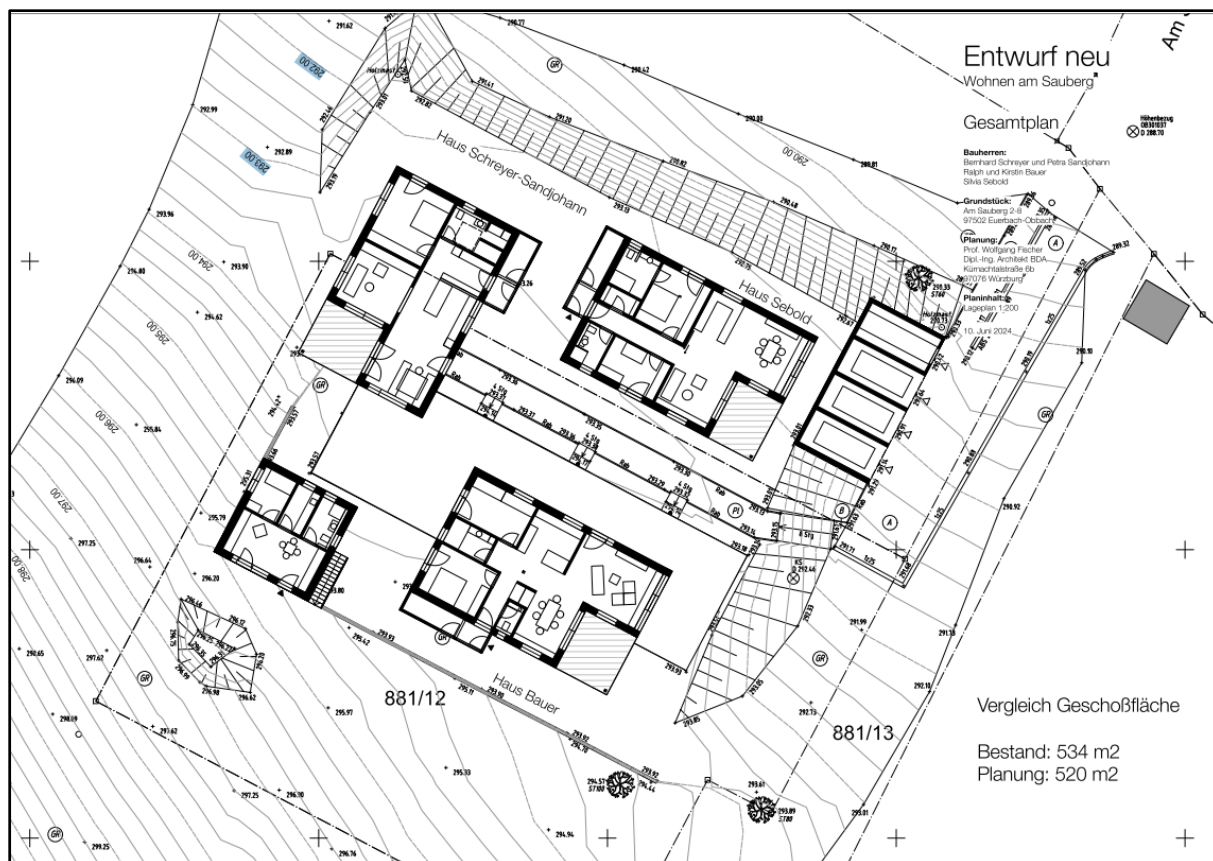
Lageplan der Neubauten und der zu sanierenden Garagen (Quelle: Auftraggeber).
